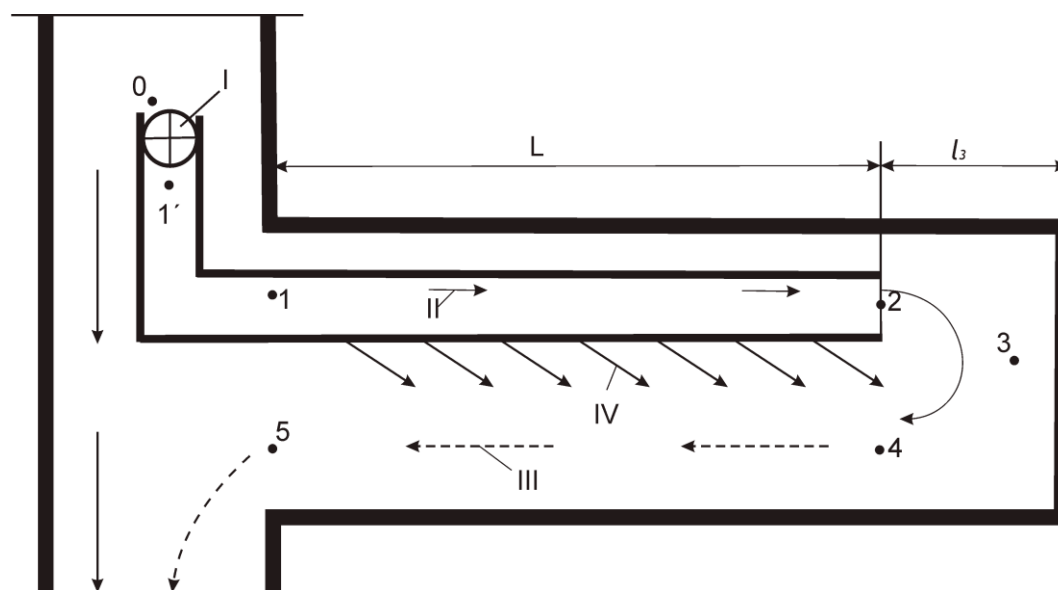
Схема тупиковой выработки при нагнетательной схеме проветривания: 0-5 – характерные расчетные пункты вентиляционного трубопровода и выработки; I – вентилятор местного проветривания (ВМП);
